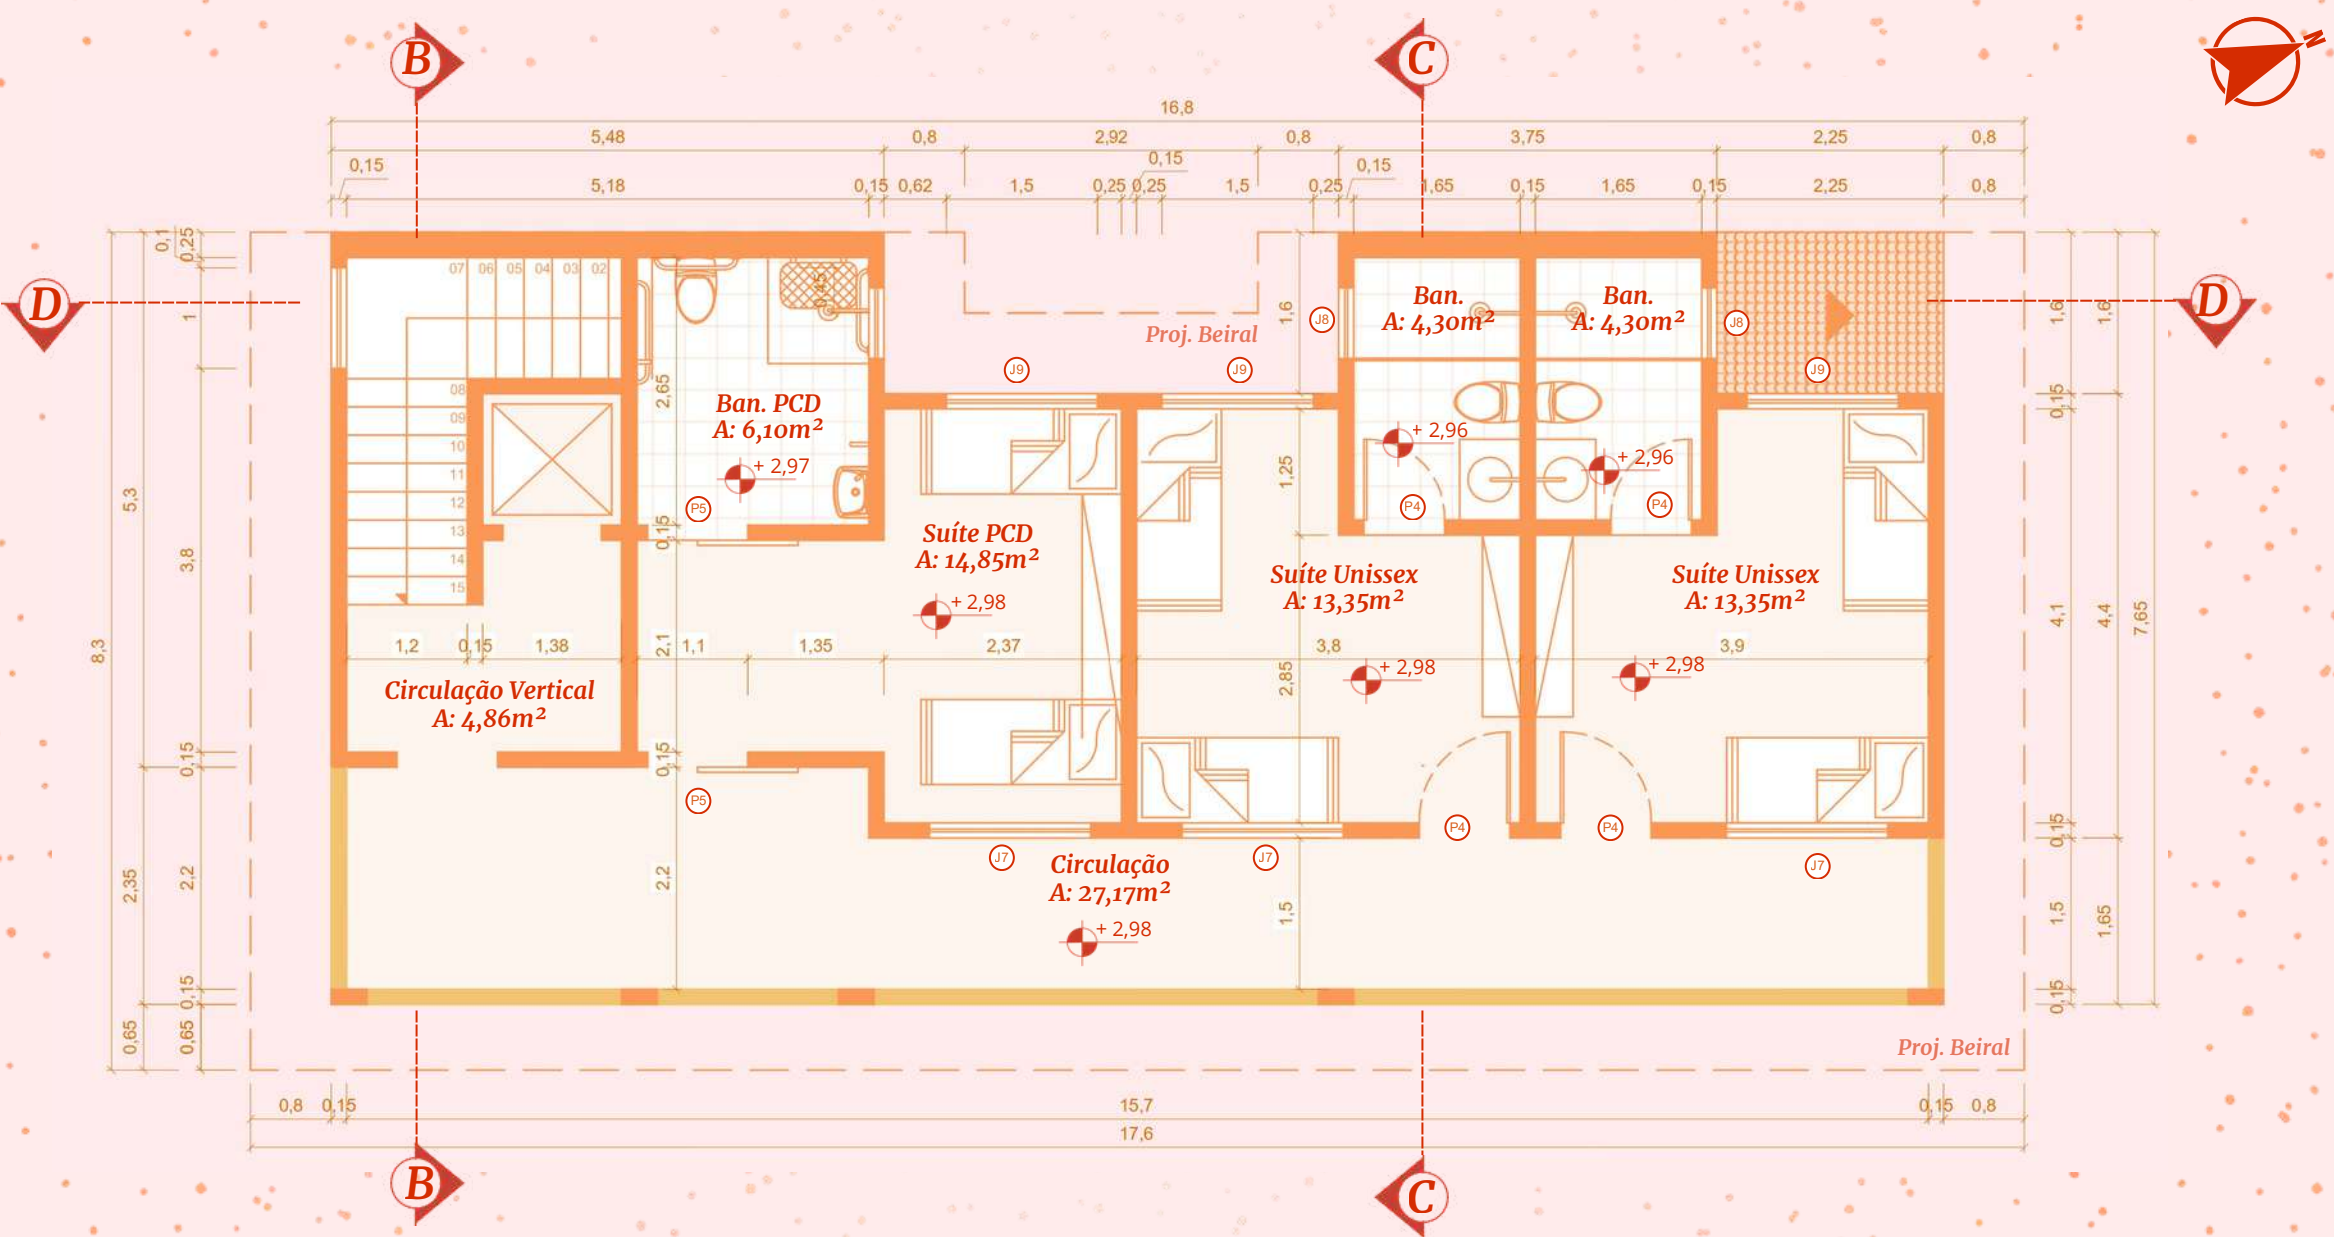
Planta baixa - Pertencer - 1º pavimento
